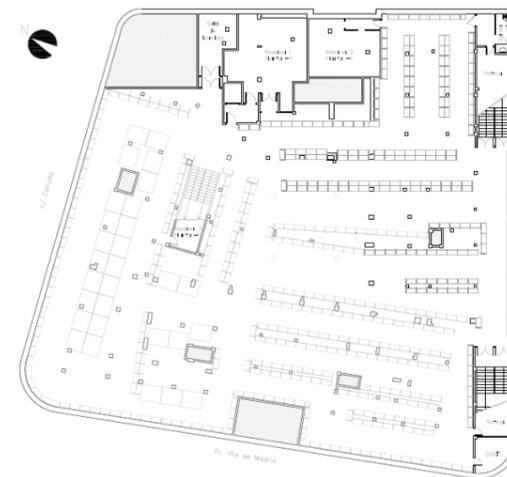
Planta Soterrani. Font: Elaboració Pròpia
